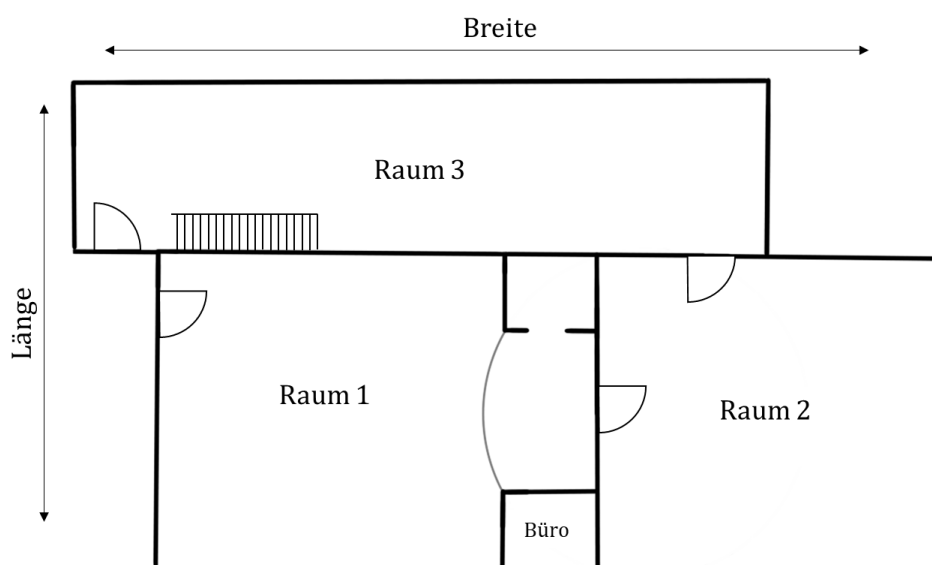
Grundriss der Ausstellung „Musikinstrumente“ im Deutschen Museum, München
